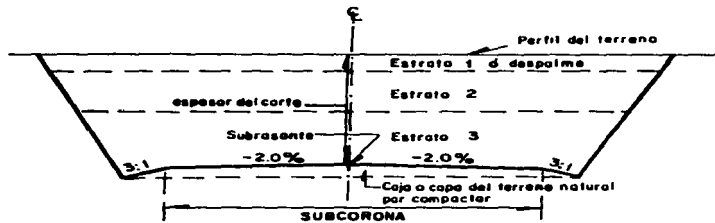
SECCION DE CONSTRUCCION DE UN CORTE EN TANGENTE.
